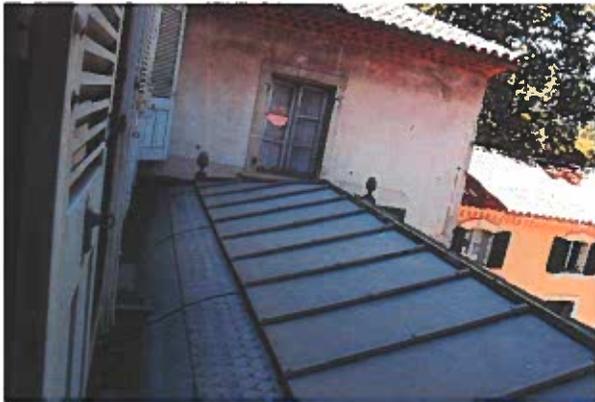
Toiture de la verrière, bon état général, photo SASU Atelier Cord
